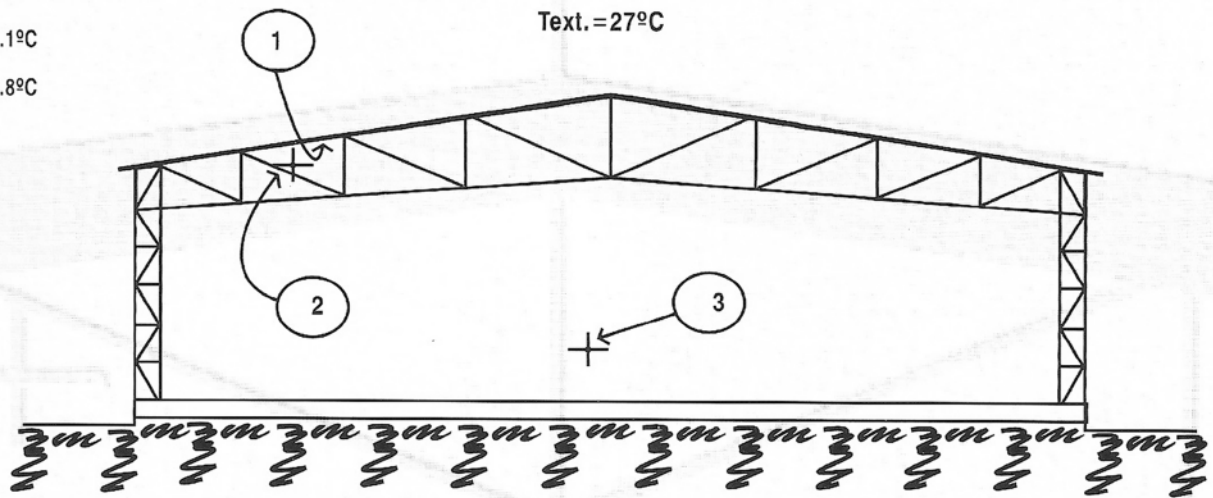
Galpón estructura y chapa metálica, no aislado, localizado en la Provincia de Buenos Aires.
